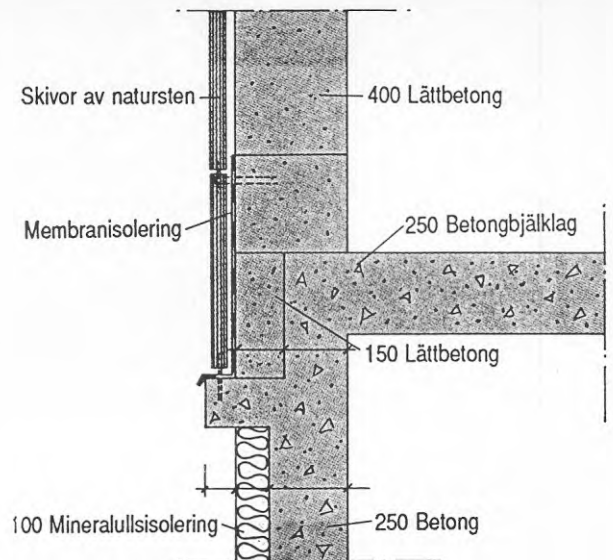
Kv Kejsaren är ett innerstadshus med källare. Lättbetongmurverket vilar på en utkragande del av betonggrunden. Utkragningen utgör en betydande köldbrygga. Grunden är isolerad på utsidan mot gata med 100 mm mineralullsisolering (markskiva). Fasaden är klädd med natursten. Källarrummet innehåller undercentral och lägenhetsförråd.
